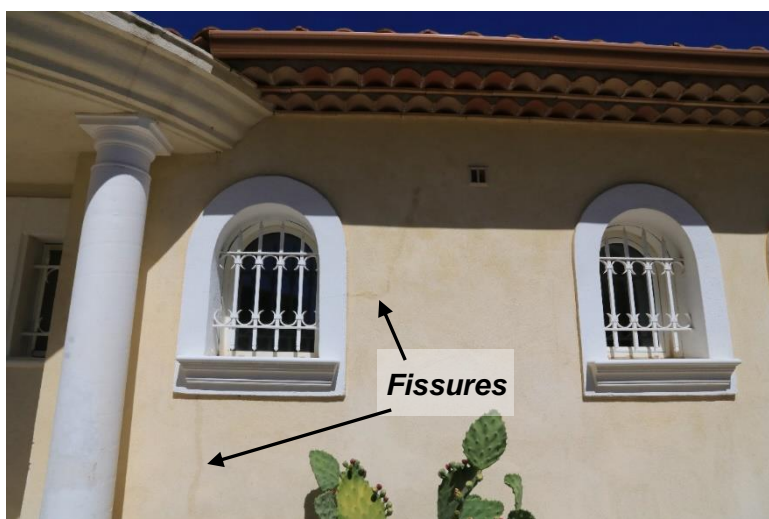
Fissures observées sur la façade de l'habitation
